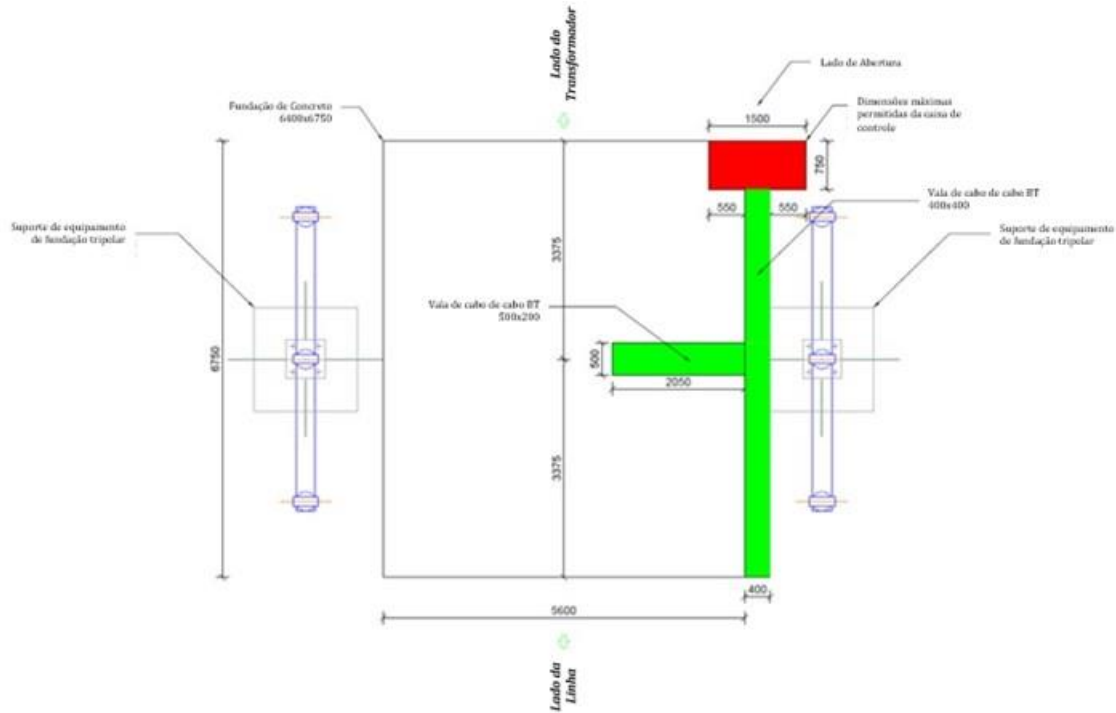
Vista de planta geral Fundação do Módulo Híbrido
